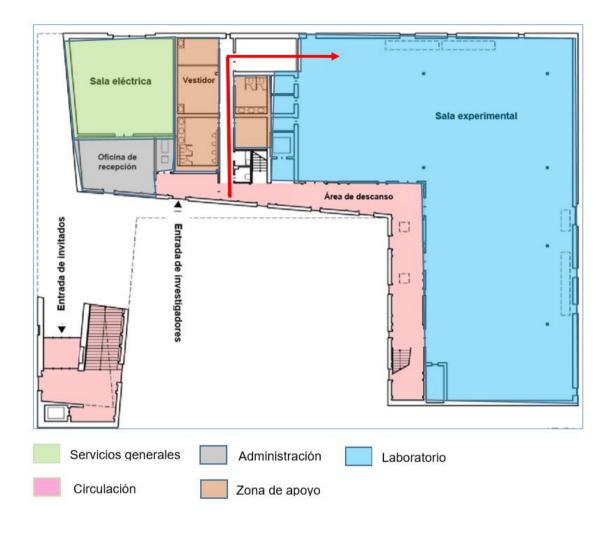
Planta 1er Nivel, SPIRALAB
